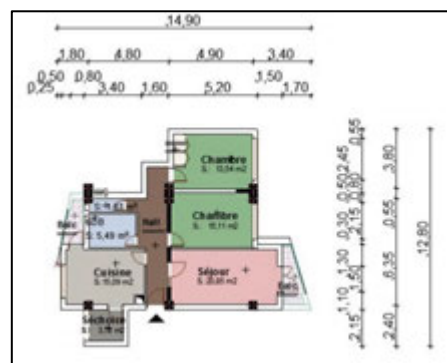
Logement F3 type 03 / Srcce :Auteur 2016
